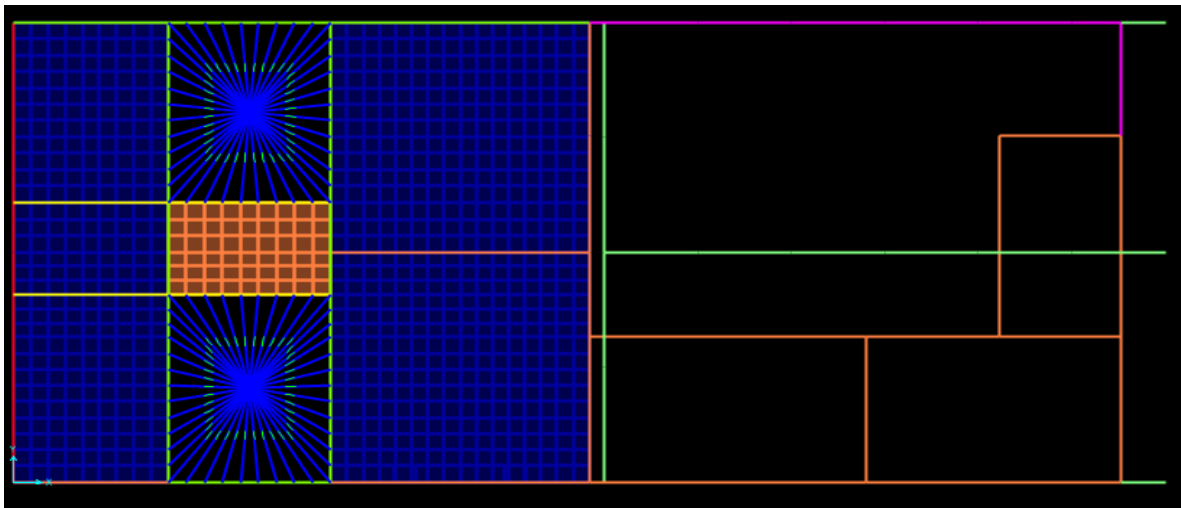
Planta de tanques Fuente Geovanny Sanchez Quesada.
